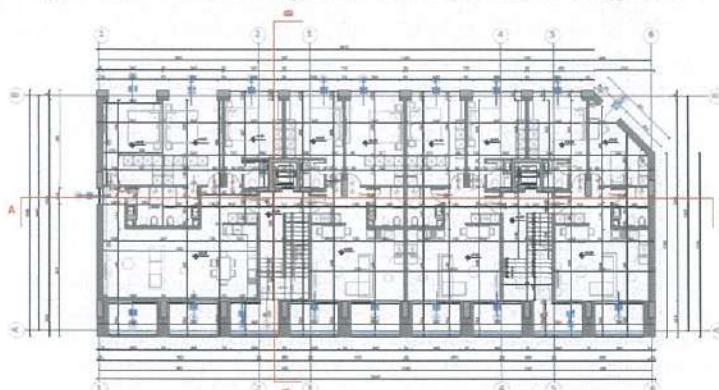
Planimetria e katit përdhe, Objekti 1, Prona Veriore
